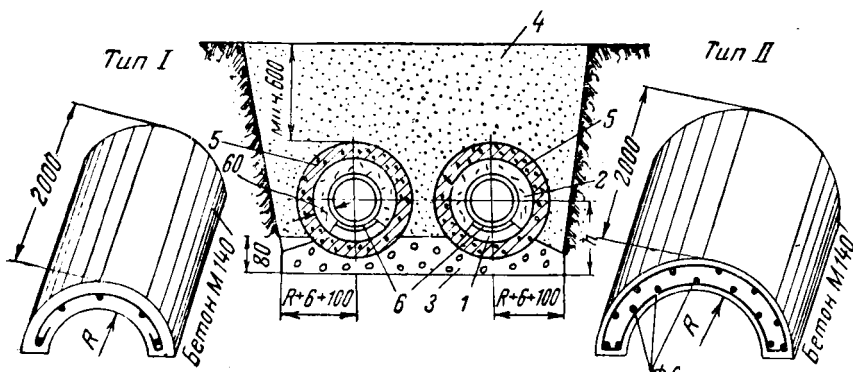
Прокладка труб в железобетонных сегментах с термоизоляцией из минеральной ваты.
